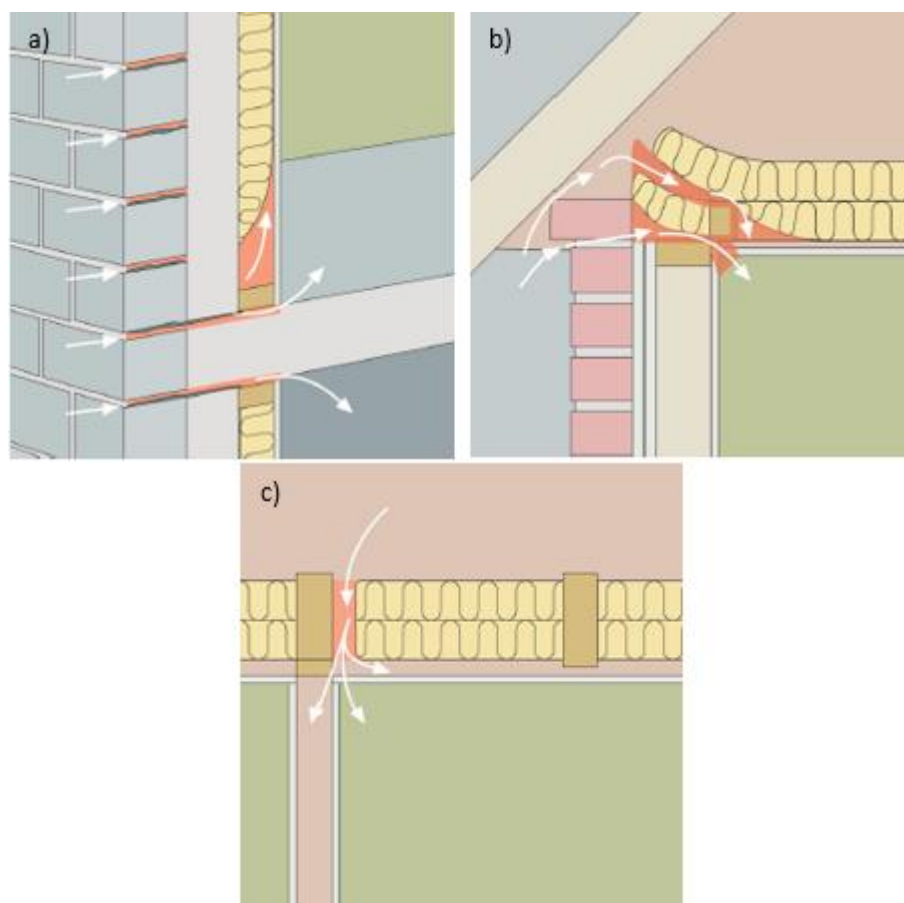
a) Infiltração de ar no soalho sobre espaço de serviço de betão devido a fendas na fachada de alvenaria b) Deficiências de isolamento no beiral de uma habitação c) Piso intermedio com as placas de isolamento colocadas incorretamente (FLIR 2010).
